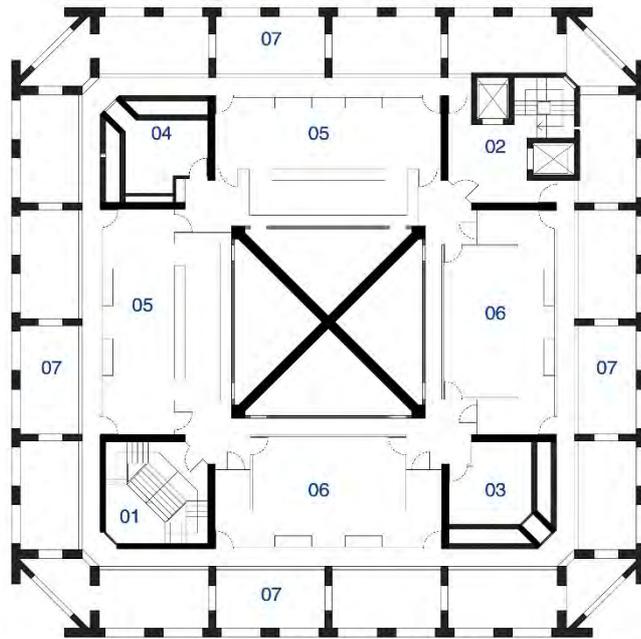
| Planta do oitavo pavimento [redesenho do autor]
